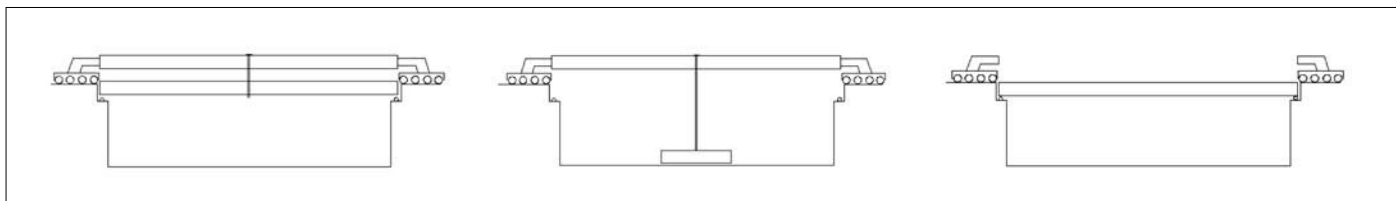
• Faze zamenjave stare in nove prekladne konstrukcije s pomočjo vrtenja le-teh okoli vertikalne osi za 90 stopinj
